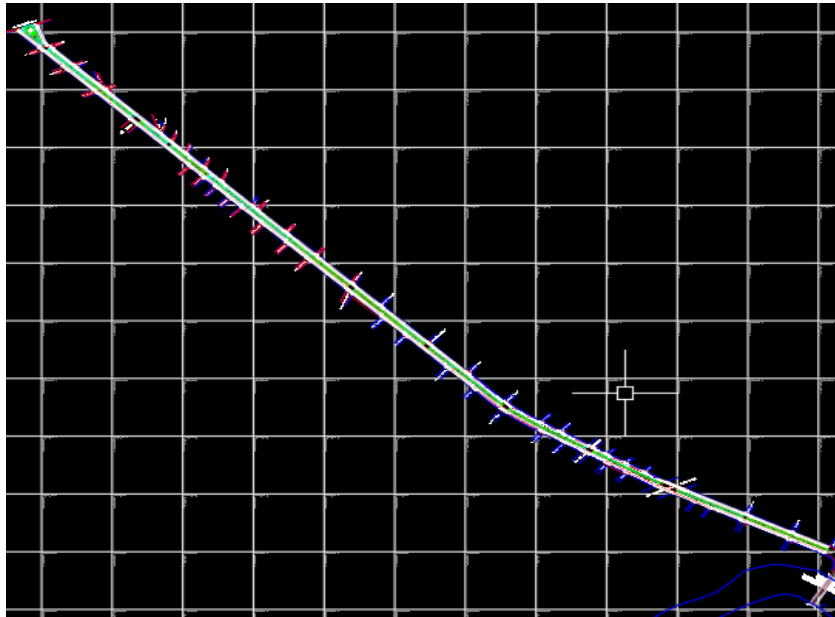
Plano de levantamiento topográfico detallado tramo 06.
